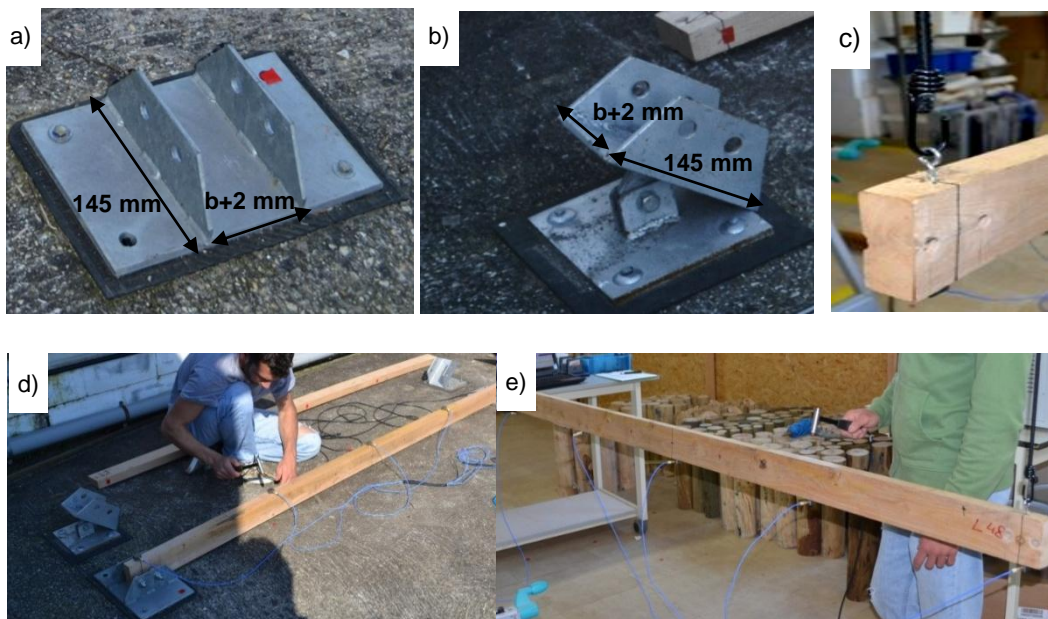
Detalles de a) apoyo tipo A, b) apoyo tipo B y c) viga suspendida con eslinga flexible (libre-libre), vista de ensayos experimentales en: d) apoyos tipo A y B, y e) viga suspendida con eslinga flexible (libre-libre).
